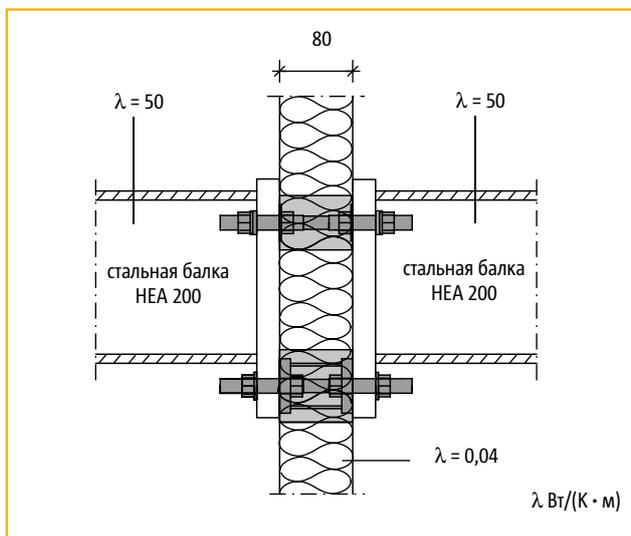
а: Соединение стальной балки HEA 200 с использованием Schöck Isokorb® тип KST 16
